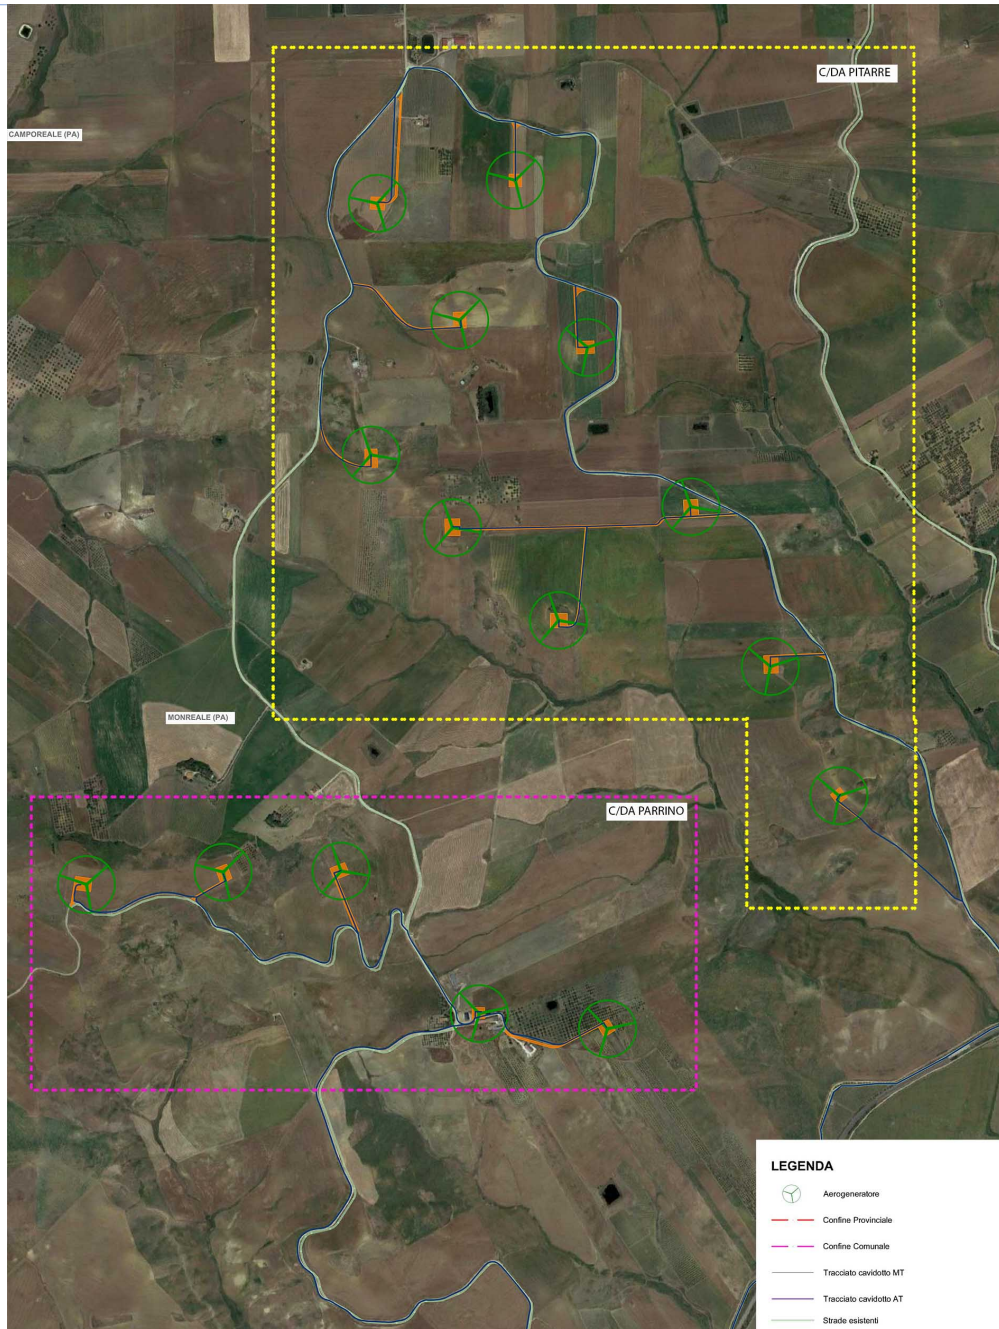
C - Ortofoto dell'area di impianto ricadente nelle Contrade Parrino e Pitarre nel Comune di Monreale (PA) e cavidotto di connessione
